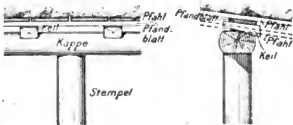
u. 38. Einzelheiten der Getriebezimmerung.
